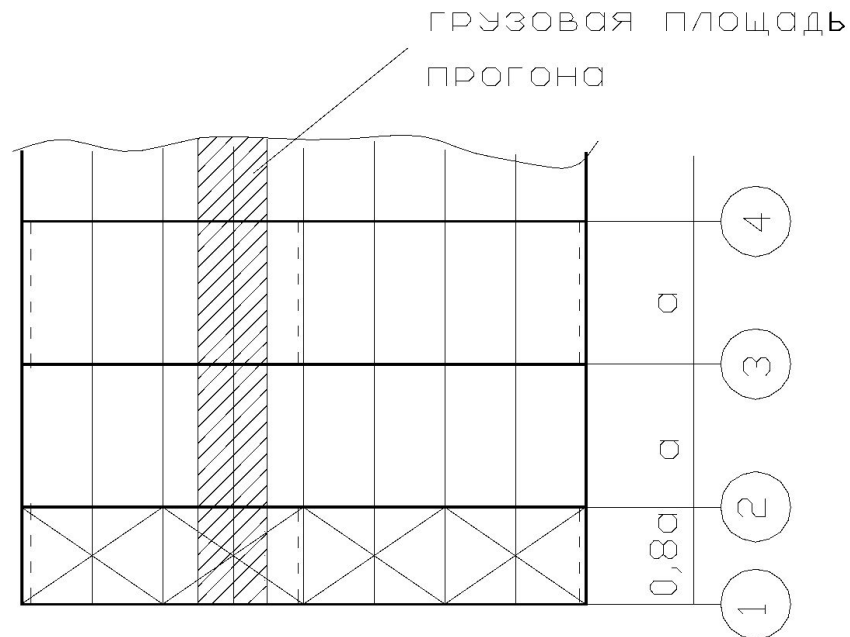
Грузовая площадь прогона при горизонтальном верхнем поясе фермы
